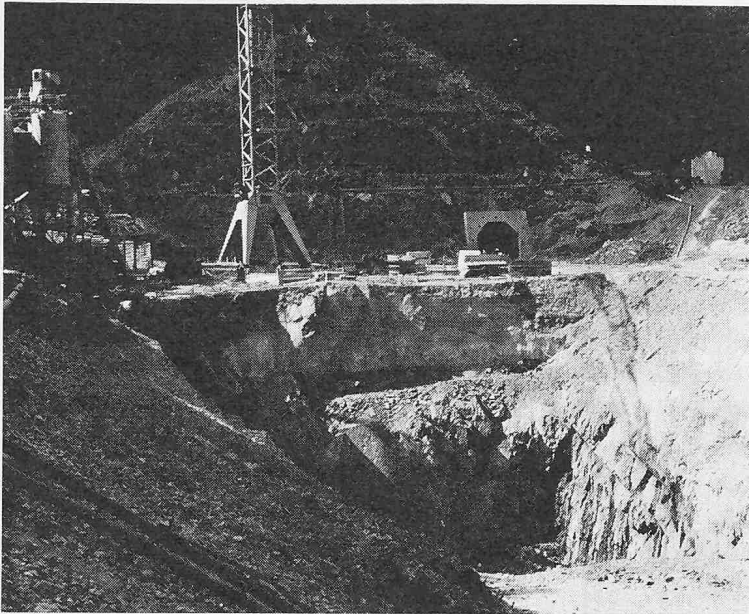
Ansicht der Baustelle, August 1970. Im Vordergrund die Baugrube des Auslaufbauwerks
